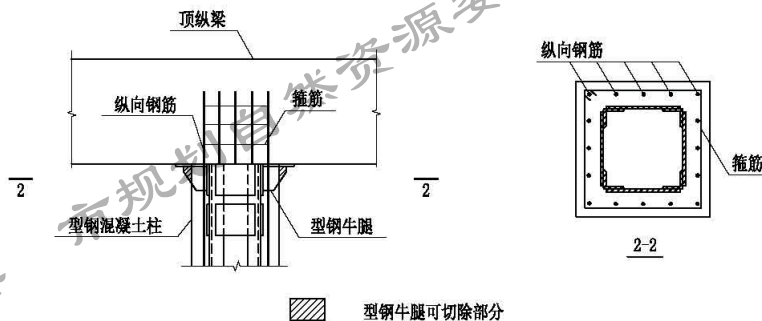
型钢混凝土柱与顶纵梁端承式连接节点示意
